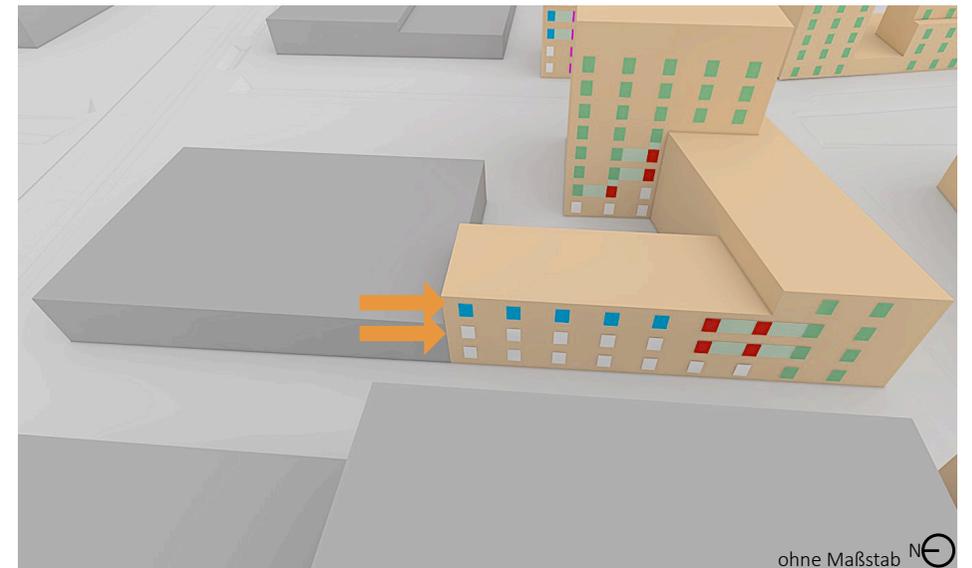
Maßnahme - QN-BF 5 Westfassade - Gebäudestand 13.08.2024
